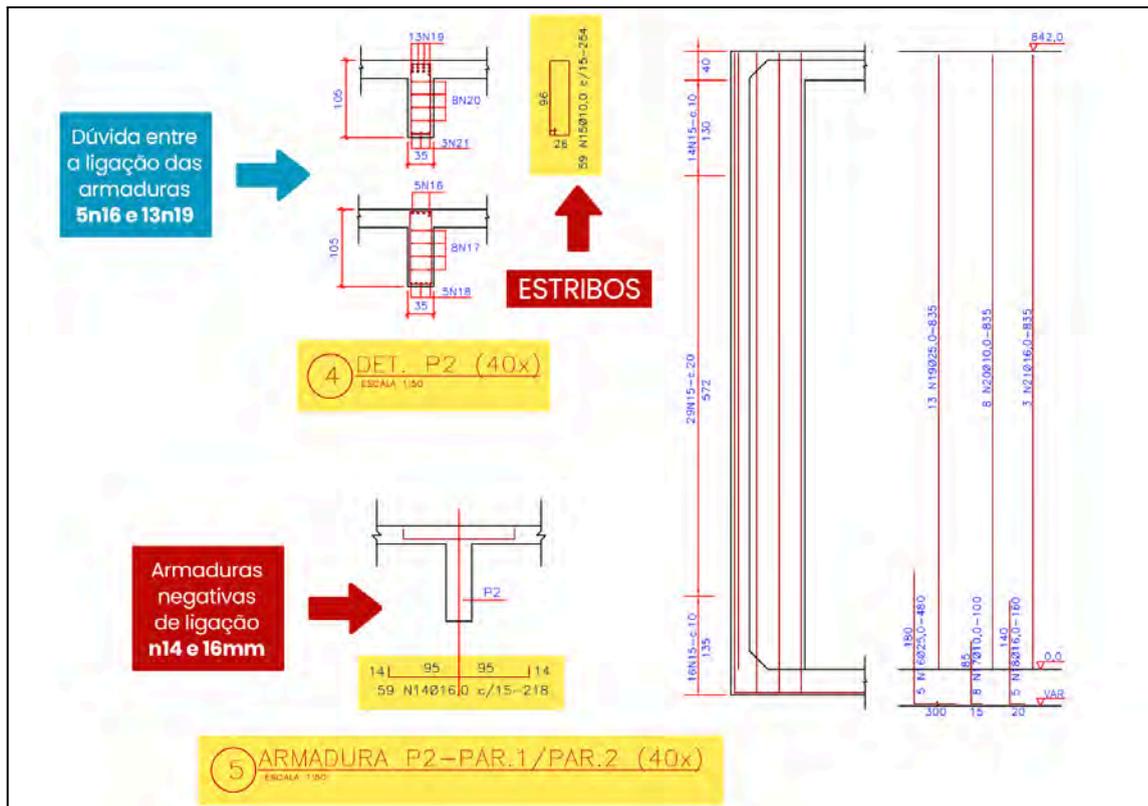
Recorte da prancha 2216-SAA-RES-EST-0100-D_MONTECRISTO-DetPilCorteA-A (anexo)
